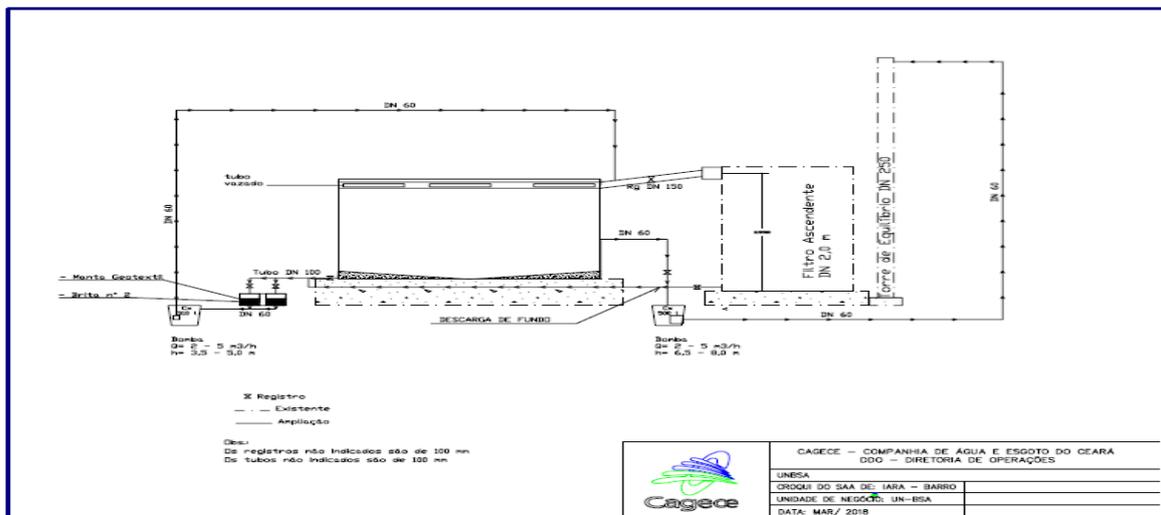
Planta Baixa e Corte da ETRG - Leitos Drenantes
